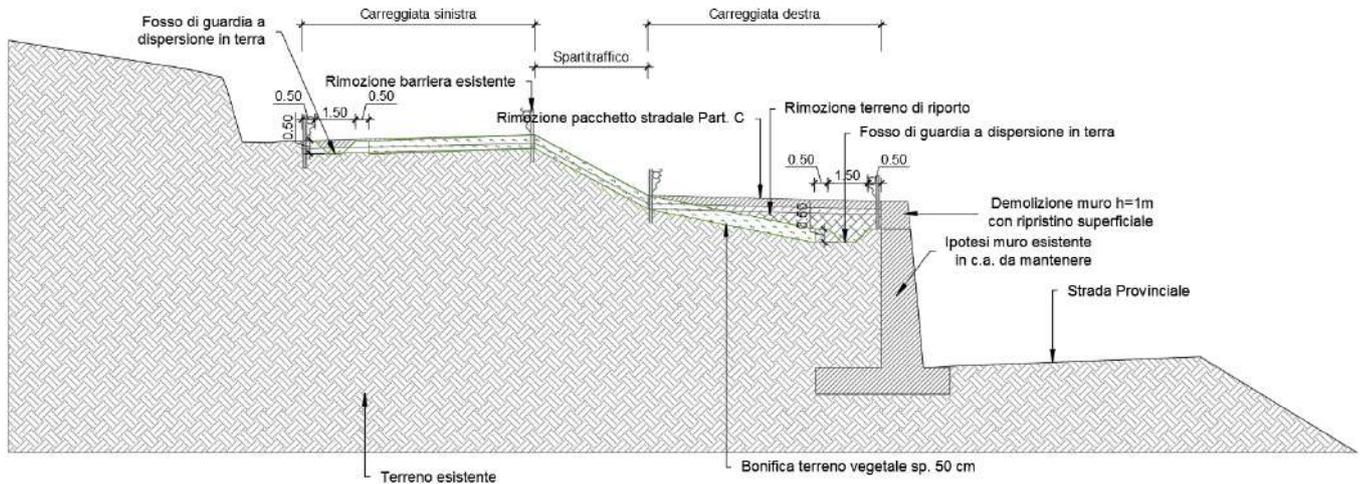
Sezione tipo D_3 mezza costa sfalsata con muro di sostegno da mantenere
